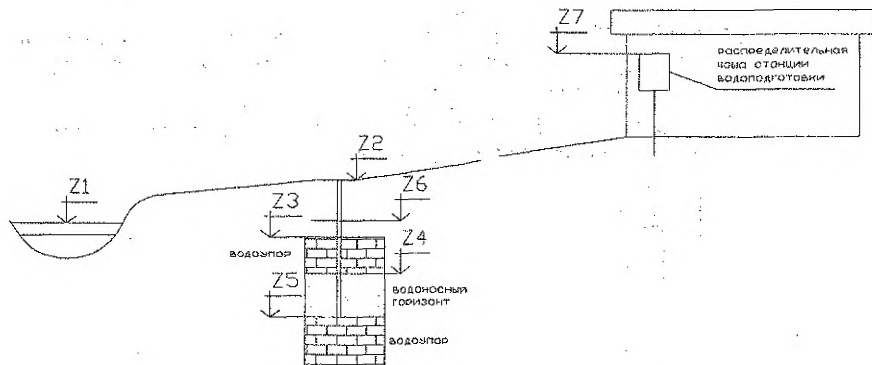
Исходные данные для расчета водозабора из подземного источника водоснабжения, с фильтровыми совершенными скважинами, забирающими воду из напорного пласта
